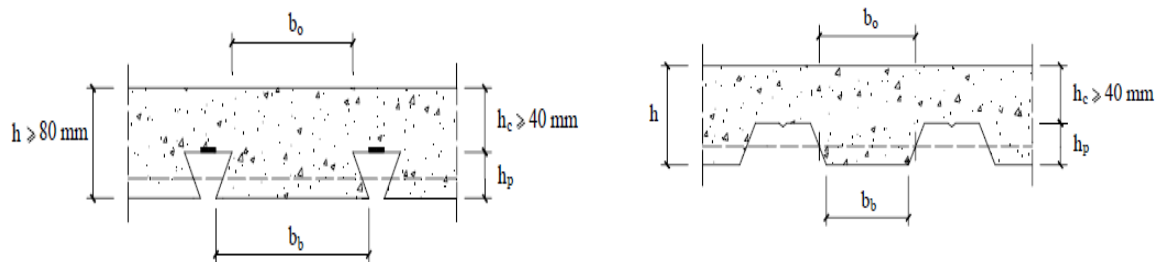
Nomenclatura para definição da geometria da chapa perfilada (Esq. – Tipo trapezoidal, Dir. – Tipo reentrante) (Alva, 2000)
